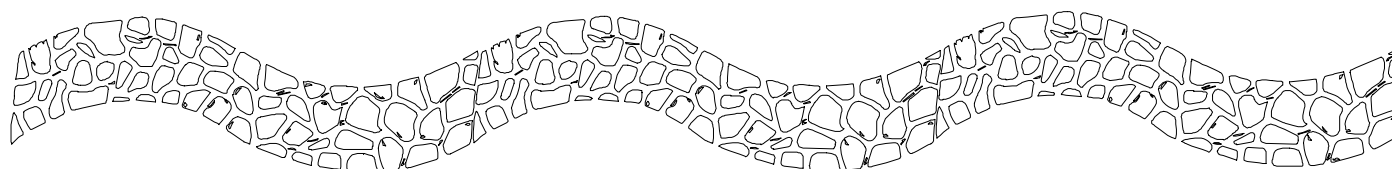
Vista en planta de un muro de piedra seca. Fuente: Imagen propia.
